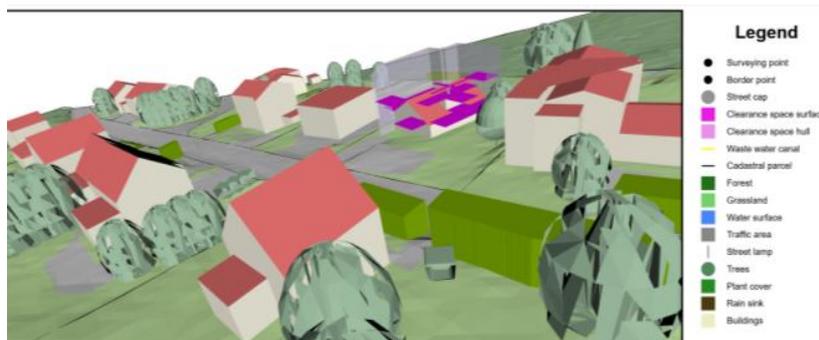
Visualisierung eines dreidimensionalen Lageplans nach der CityGML SitePlan ADE (Müller 2021).
